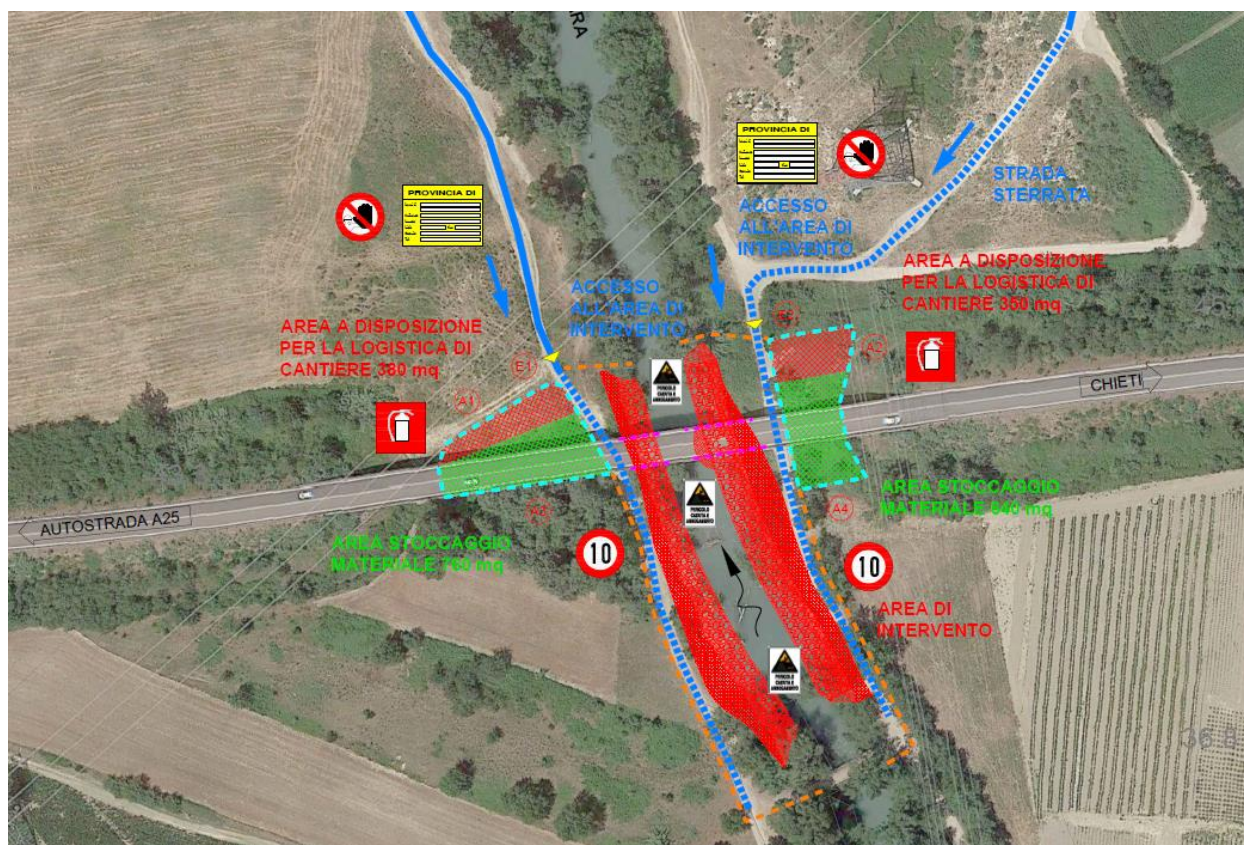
Stralcio Planimetria di cantierizzazione – Progetto esecutivo - interventi di adeguamento e messa in sicurezza urgente (M.I.S.U.) delle Autostrade A24 e A25 art. 1 comma 183 Legge 228/2012
